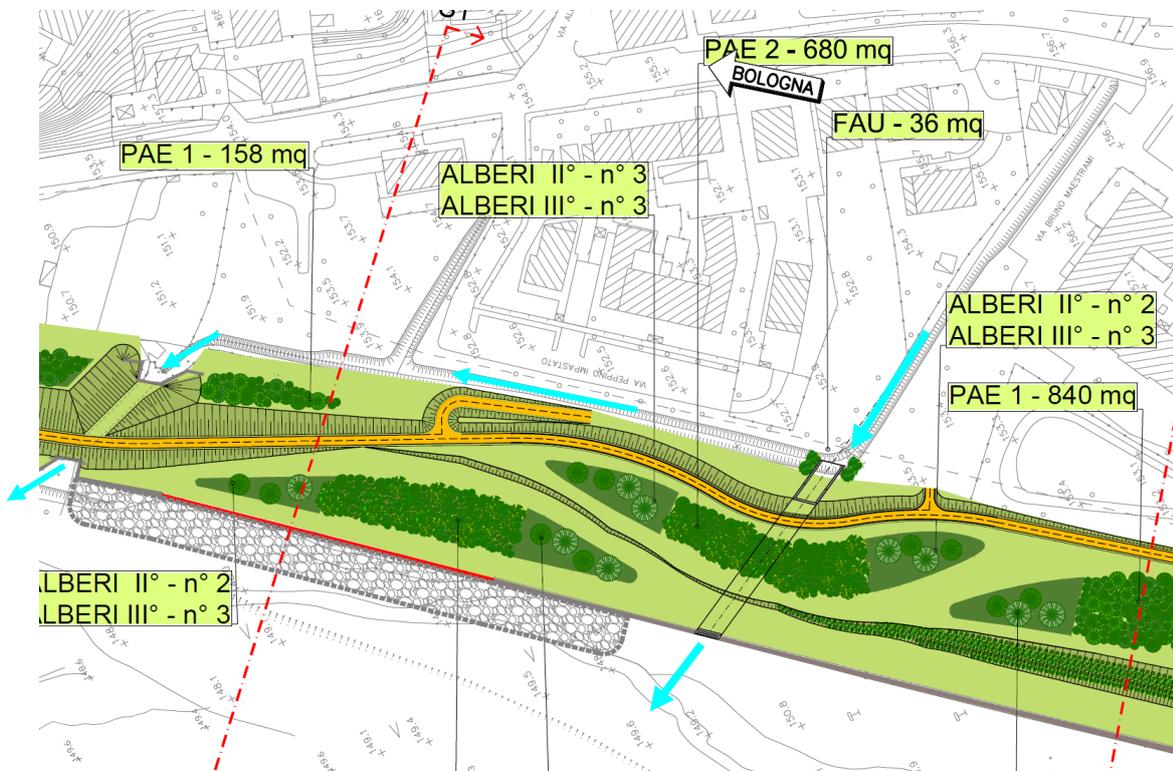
Estratto planimetria opere a verde. Nuovo attraversamento idraulico
